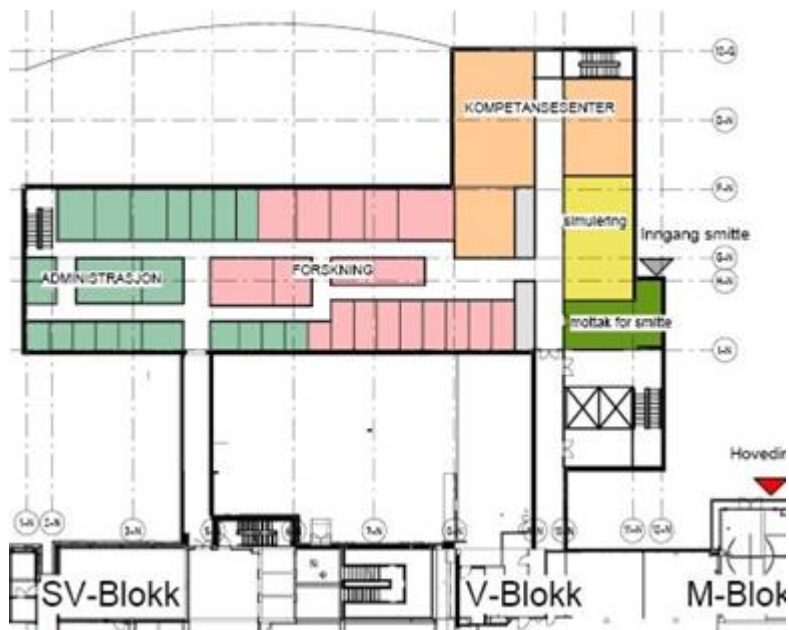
Illustrasjon; Situasjonsplan, Nordalternativet.
